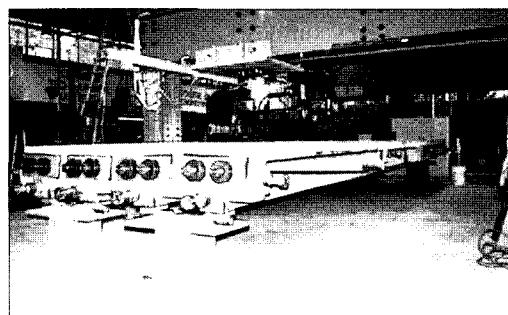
Precast prestressed bridge model using Fiber Reinforced Polymer tendons
